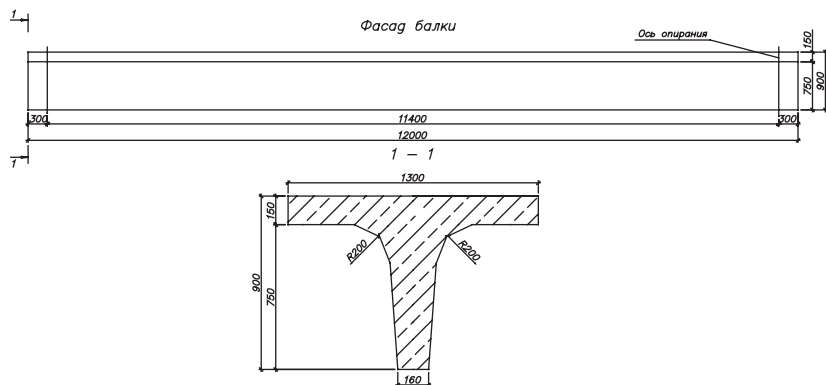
Конструкция полномасштабных железобетонных балок длиной 1200 см
